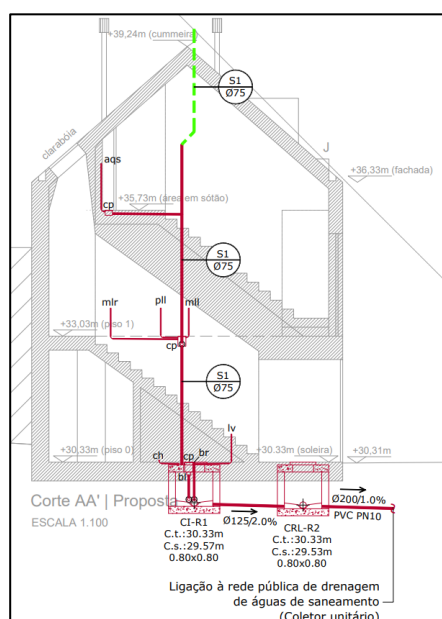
Corte transversal com o traçado da rede (a habitação A tem traçado semelhante)
